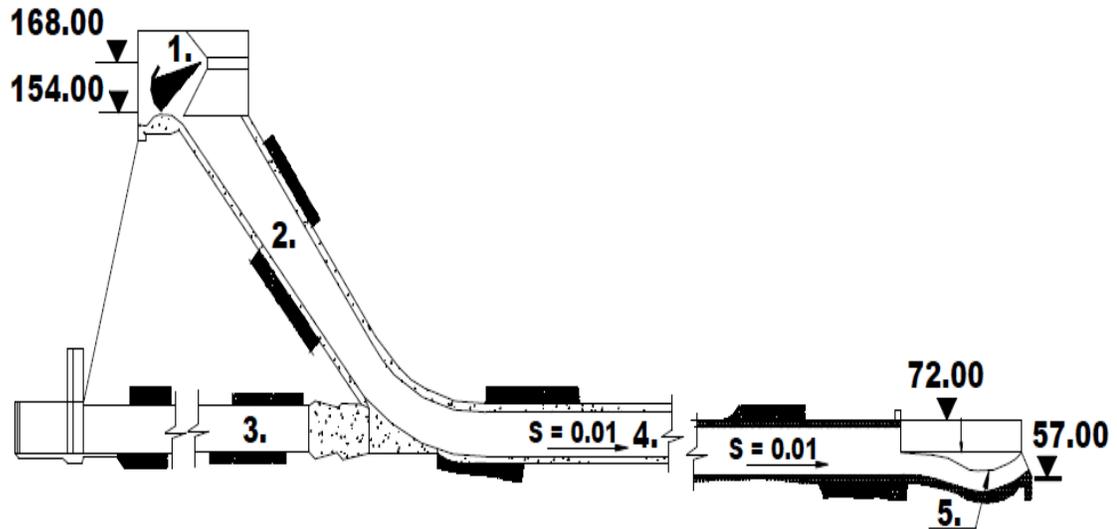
Vertedor en Túnel, Presa El infiernillo, Gro. Michoacán.
